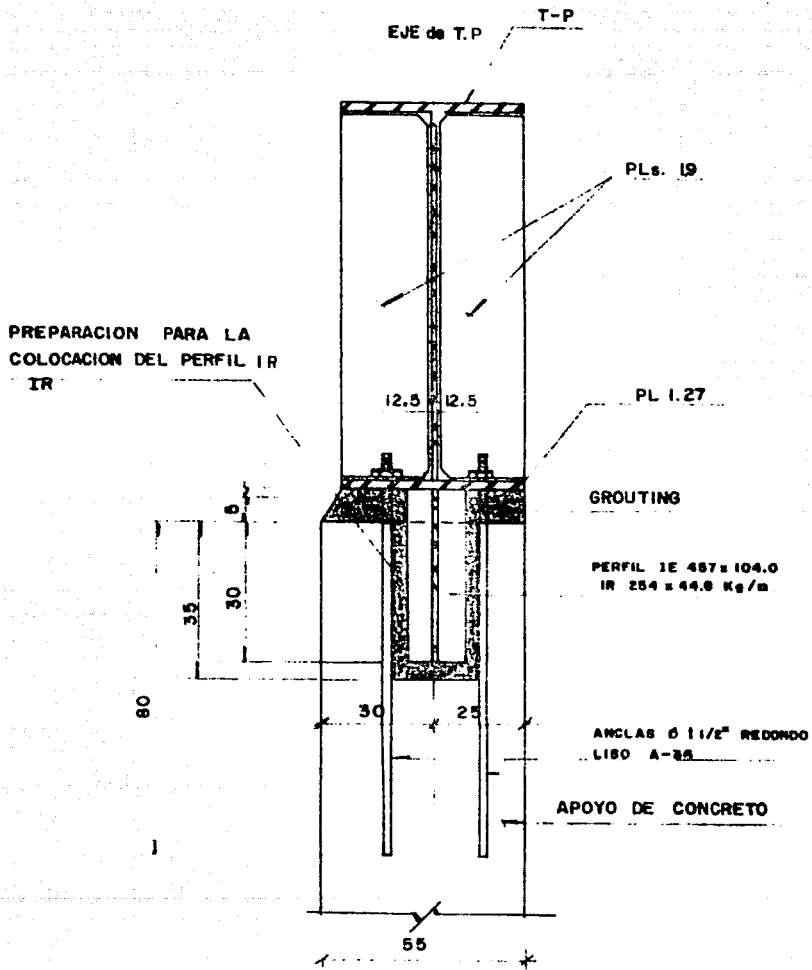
ANCLAJE DEL MURO TAPON A LA ESTRUCTURA METALICA.
